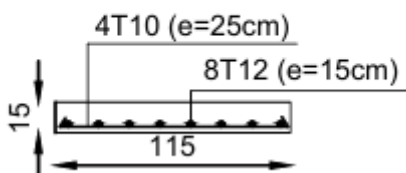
schéma du ferrailage d'escalier (volée B)
